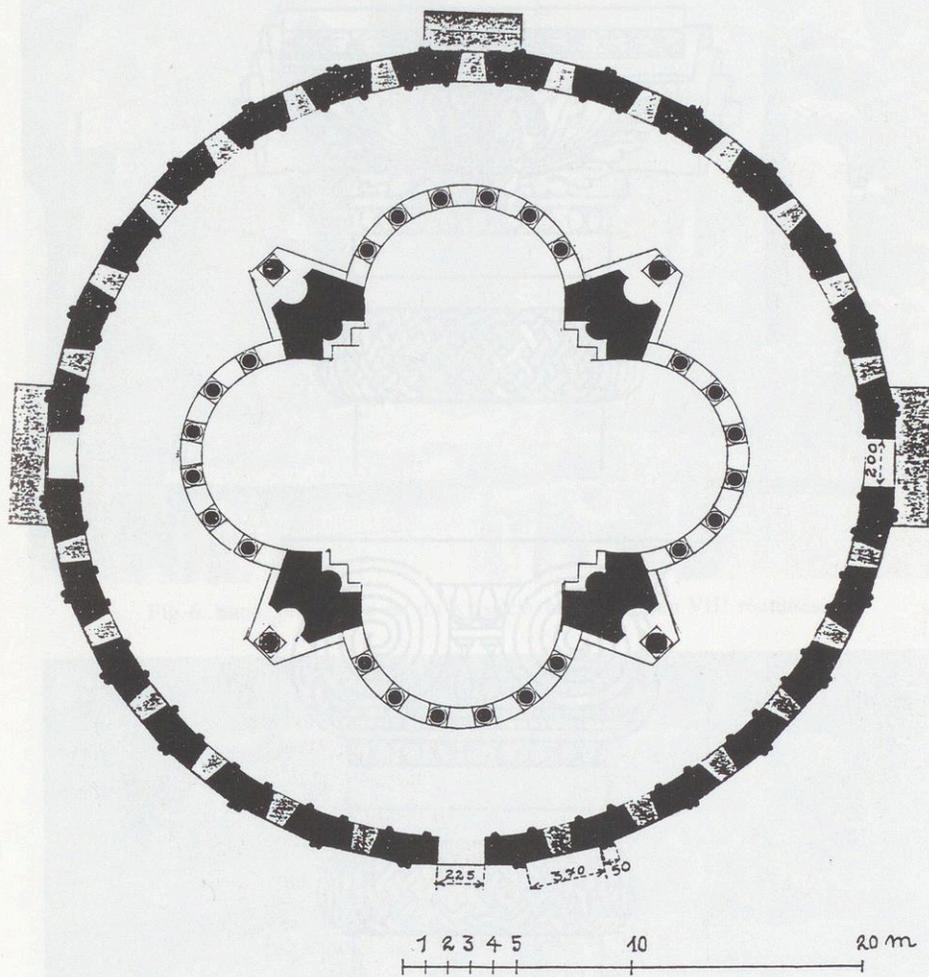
Bana, plan du tétraconque du VII<sup>e</sup> siècle, essai de restauration.
